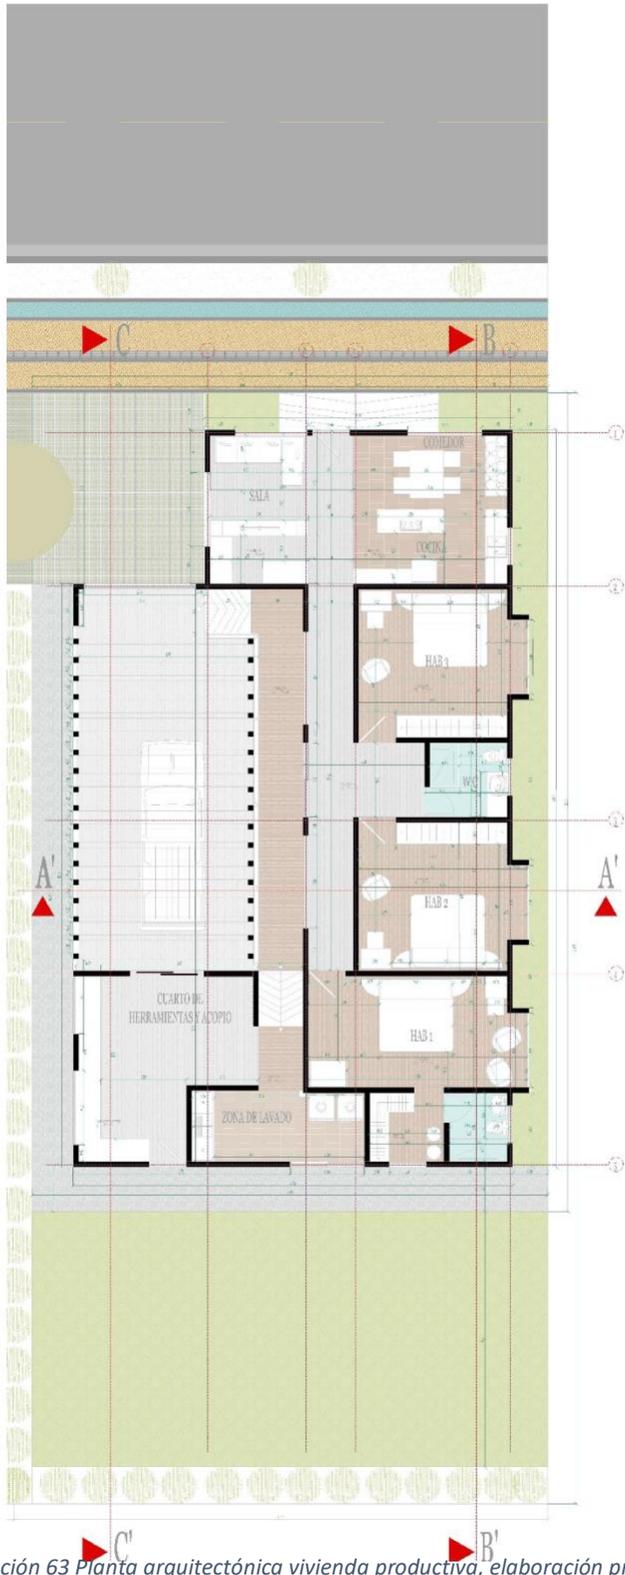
Planta arquitectónica vivienda productiva, elaboración propia
